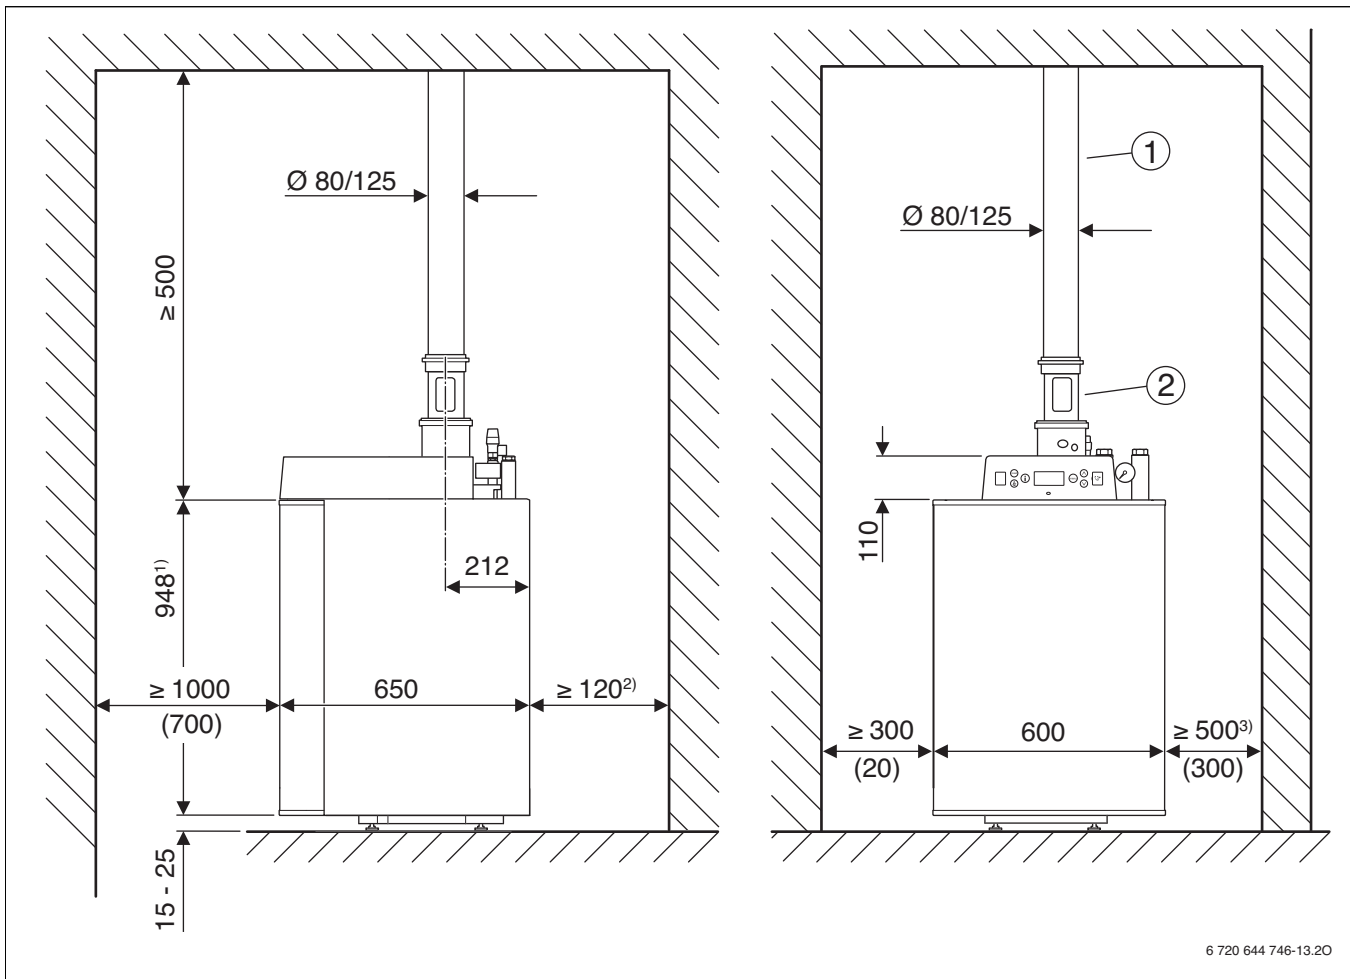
Einbaumaße bei senkrechter Abgasführung (die in Klammern angegebenen Werte sind Mindestmaße)
